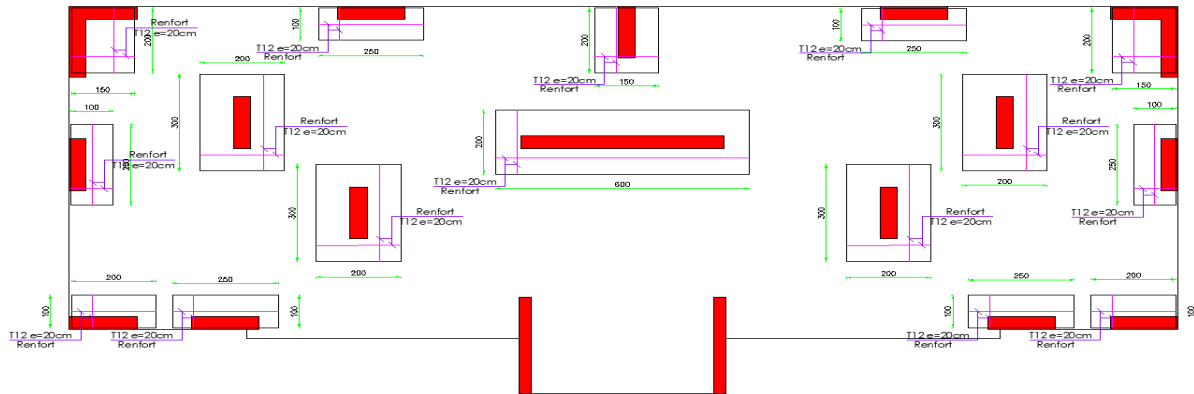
Plan de ferrailage des renforcements de la dalle
